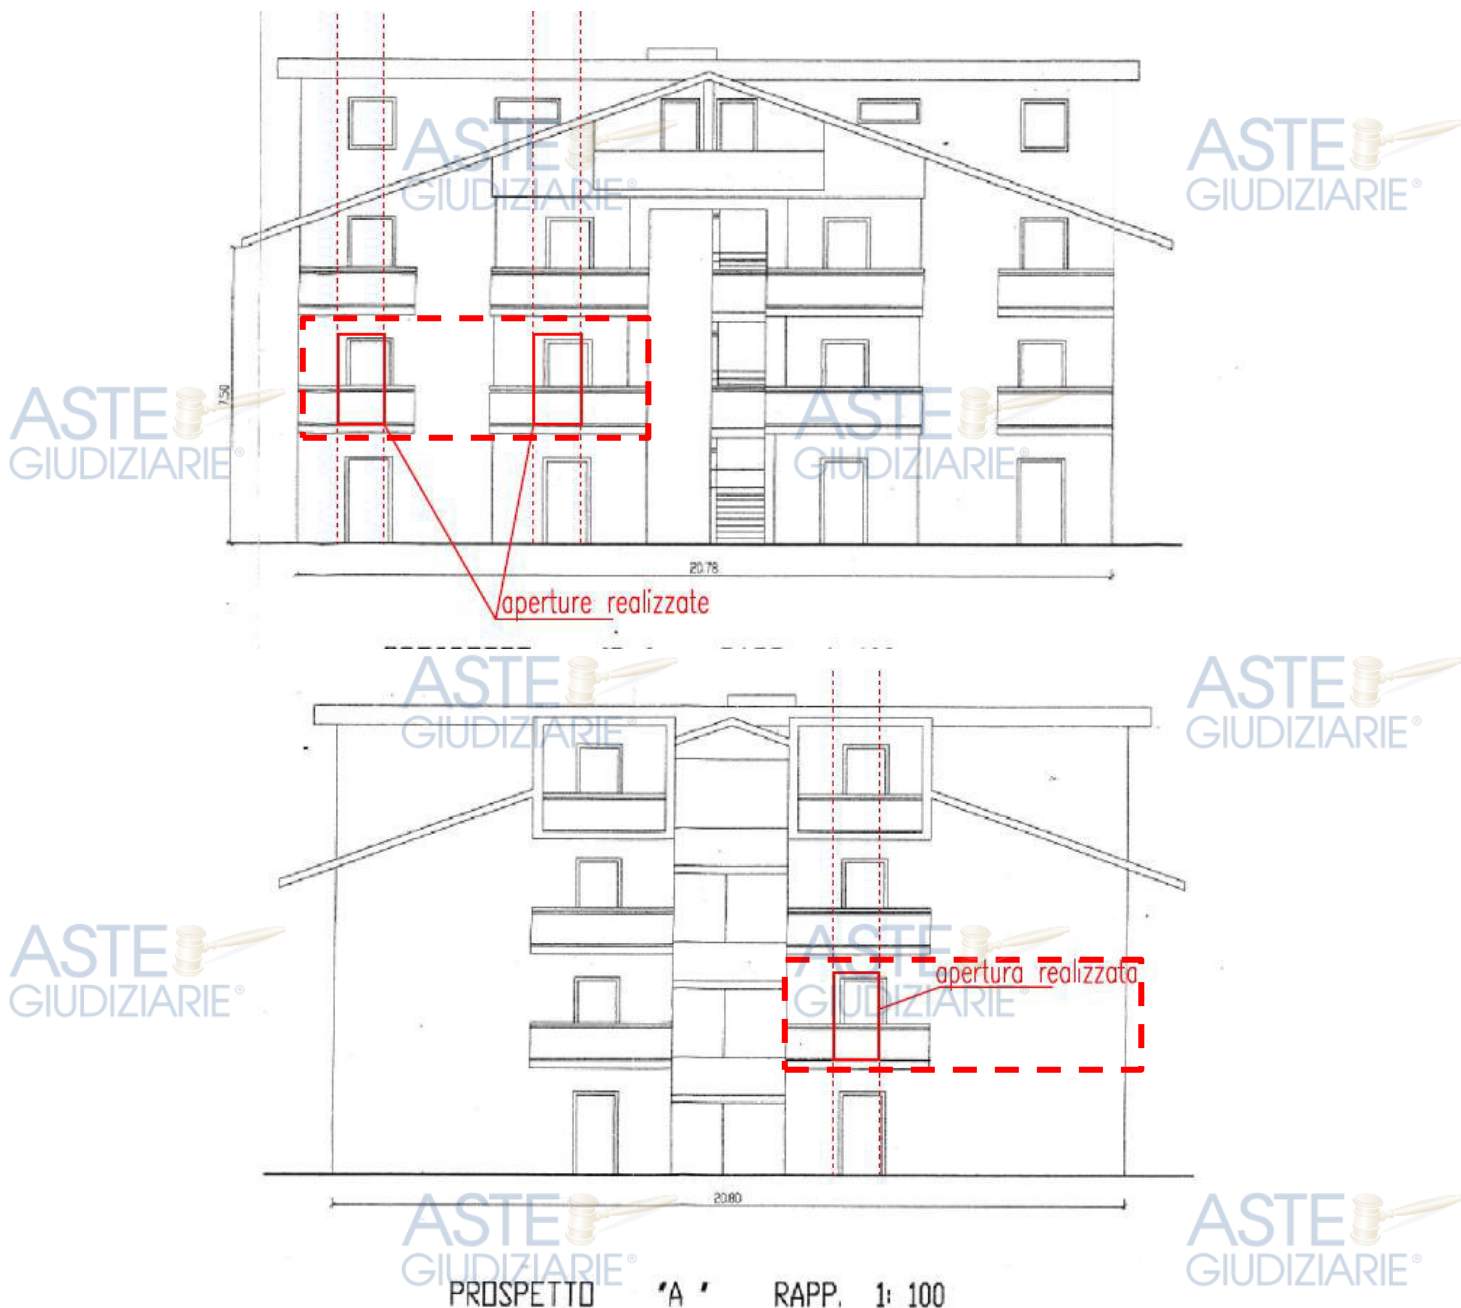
I due prospetti con le posizioni delle aperture dell'appartamento, di fatto in posizione lievemente traslata rispetto al progetto, e di altezza maggiore.
